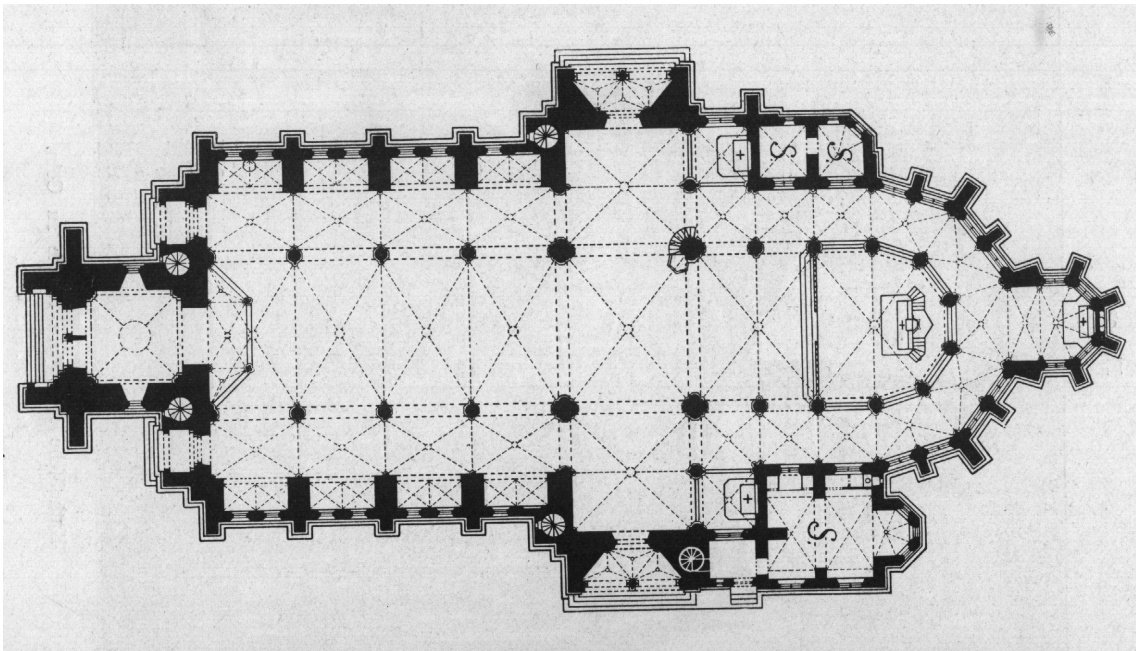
Grundriss, in: Herz-Jesu 1993, S. 17
